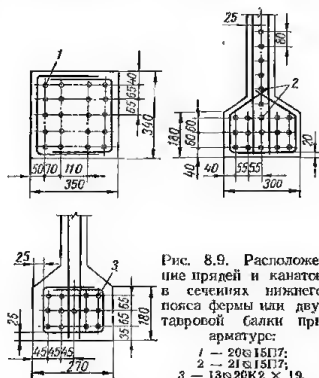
Расположение прядей и канатов в сечениях нижнего пояса фермы или двутавровой балки при арматуре:
